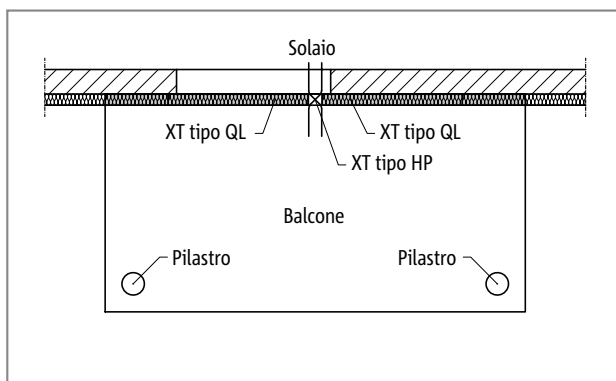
Schöck Isokorb® XT tipo QL: balcone con appoggio su pilastri
